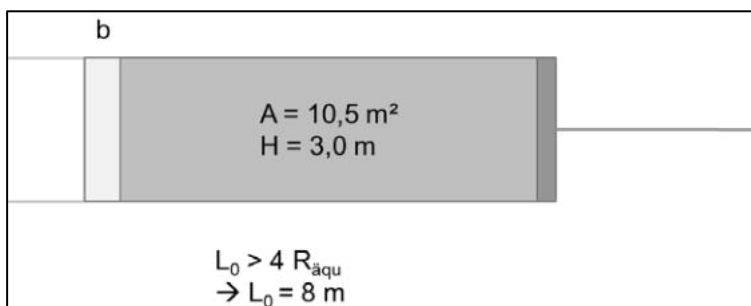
Grundaufbau eines zukünftigen in situ Streckenschlussbauwerkes mit Druckkammer
